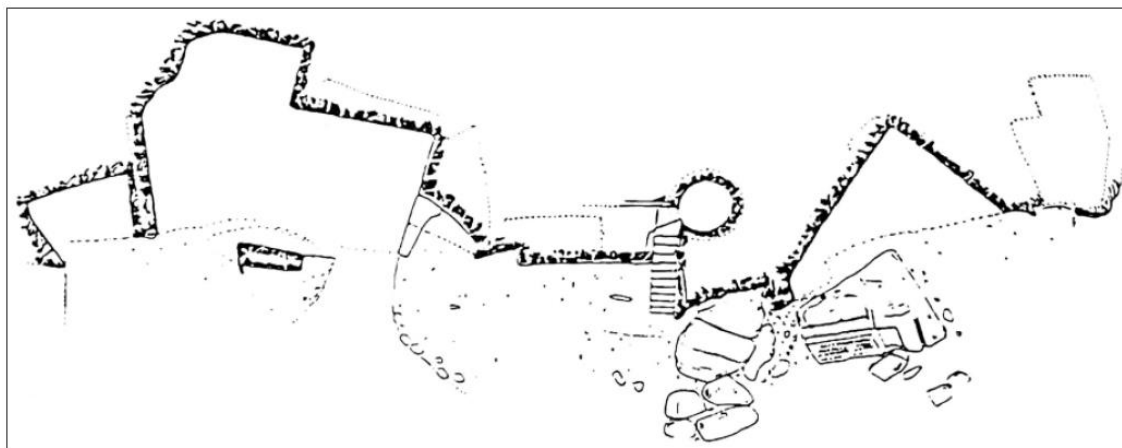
Noto Antica. Planimetria del ginnasio (da FERRARA 2020a, 162)
